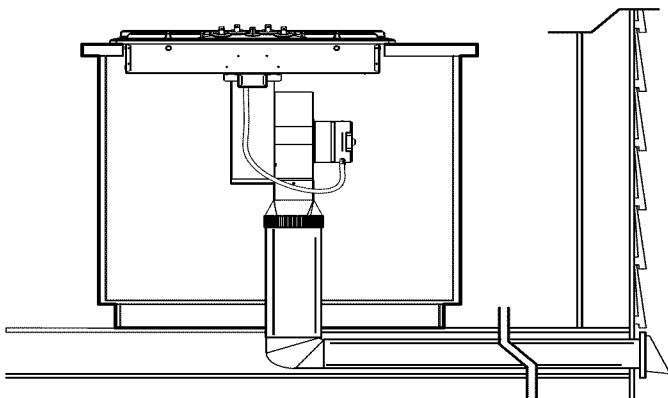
DUCTO QUE ATRAVIESA EL PISO
